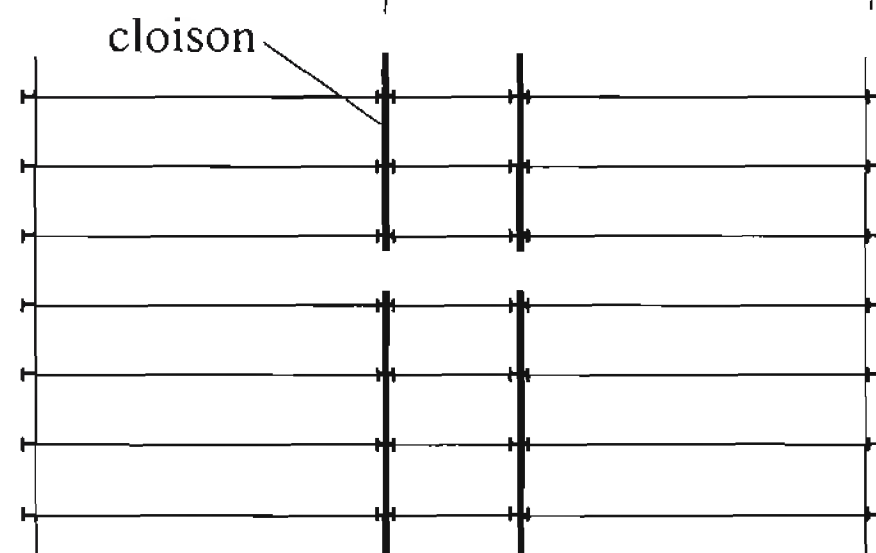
Planchers à un niveau de poutres (tiré de [4.1]).
